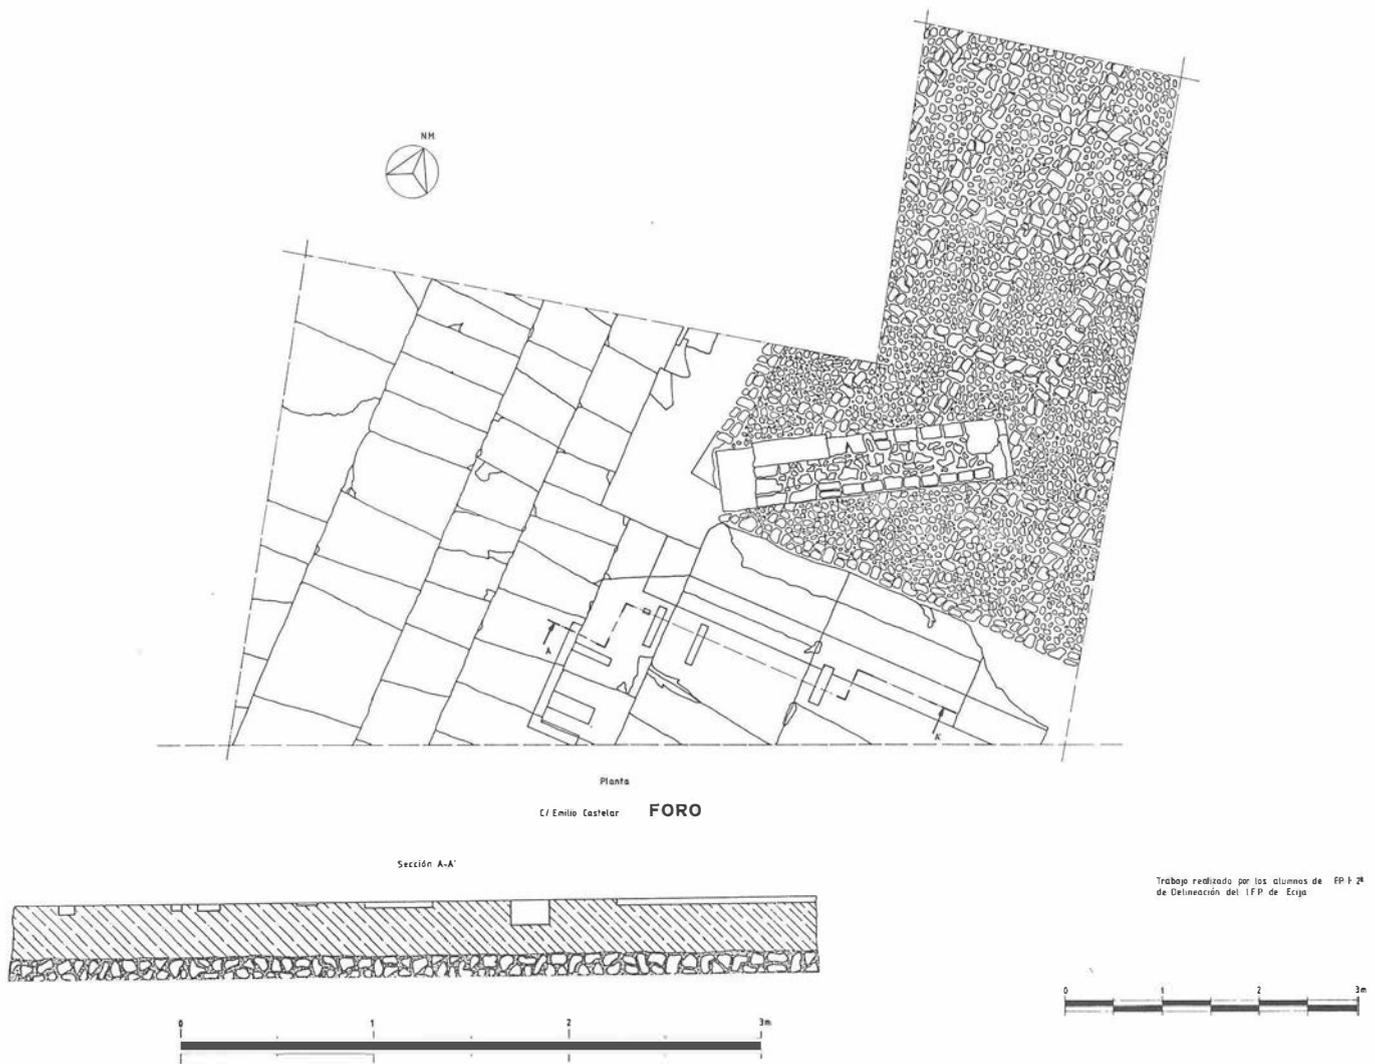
C/ Emilio Castelar. Foro. Planta y sección.
